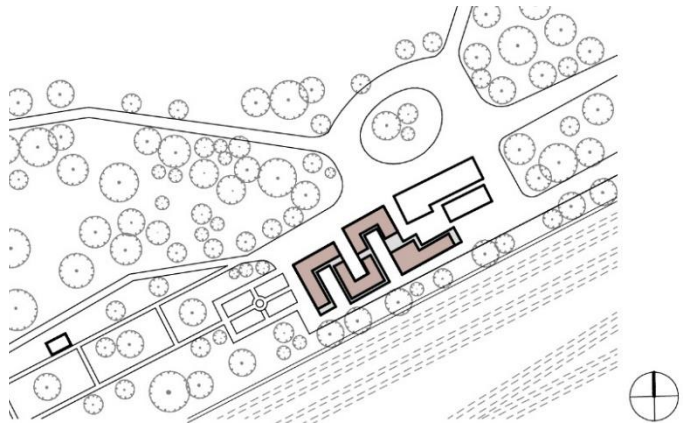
Lageplan Übernachtungsstätte in Frankfurt
